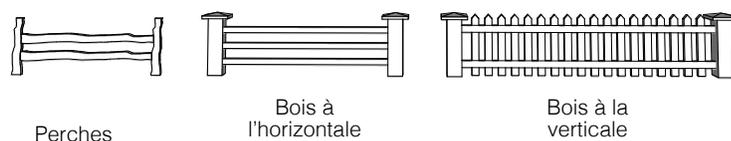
Clôture en bois, perches ou assemblage avec acier ou aluminium
